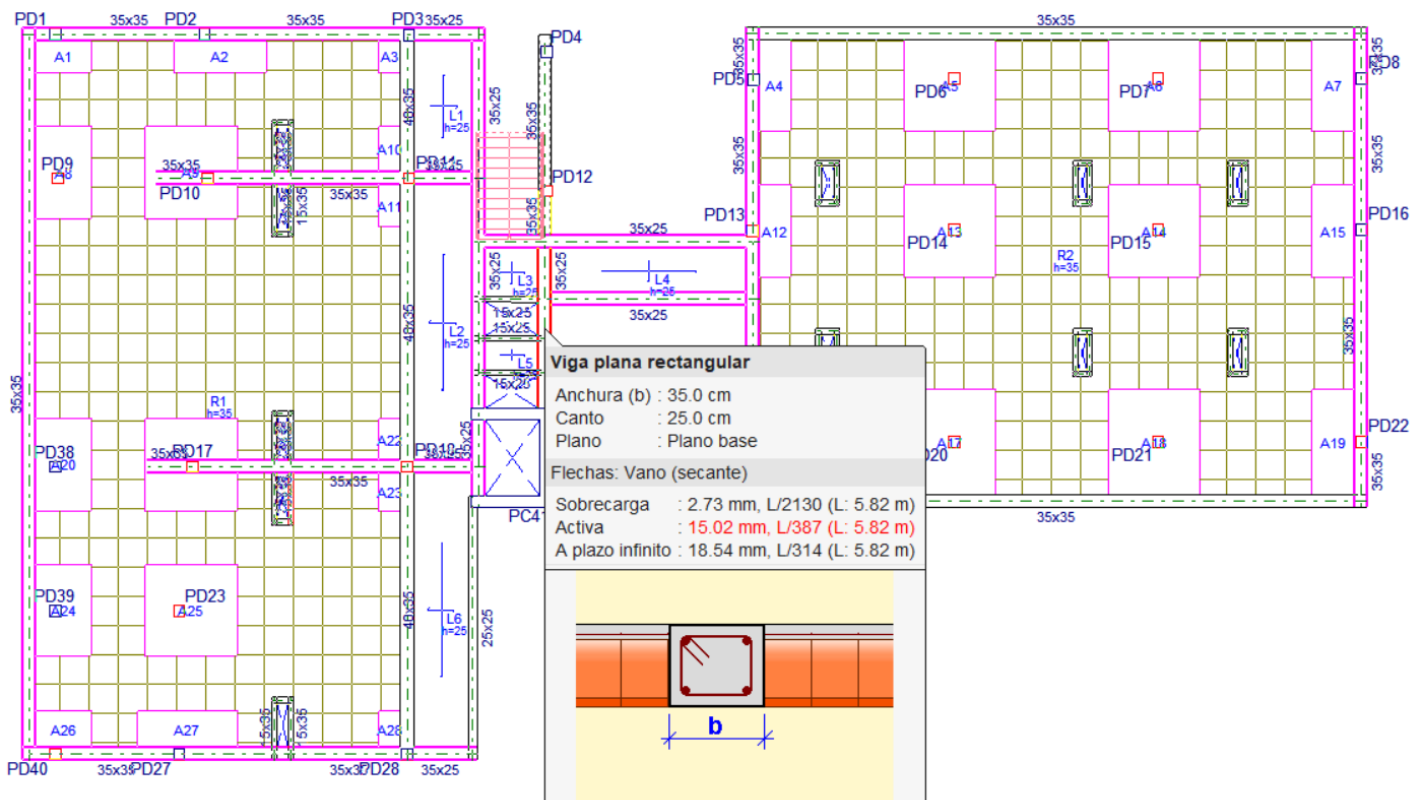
Flechas en Vigas, Planta Tercera, Módulo D
